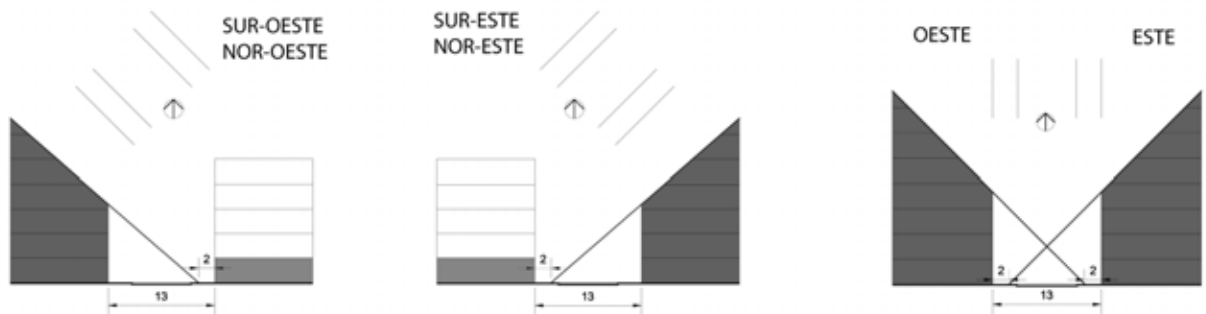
Construcción de los perfiles que garantizan el acceso solar y los derechos solares a través de las líneas de sección para aceras para la ciudad de Bogotá, centro (4,5° Norte). Fuente: Elaboración propia
